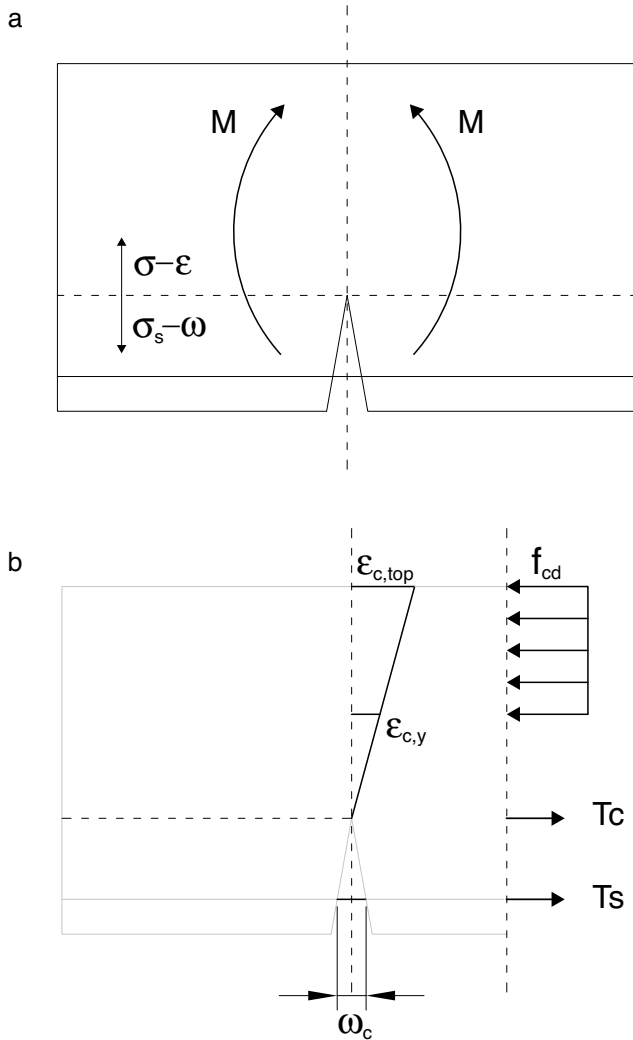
Criterios de fallo: a) zona fisurada-no fisurada; b) deformación en la zona comprimida.
